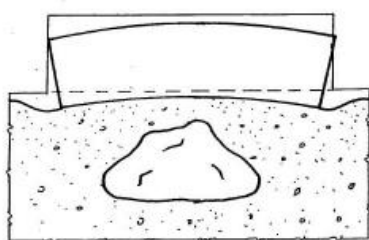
c - Influenza di un trovante sulla deformazione di un edificio allungato
